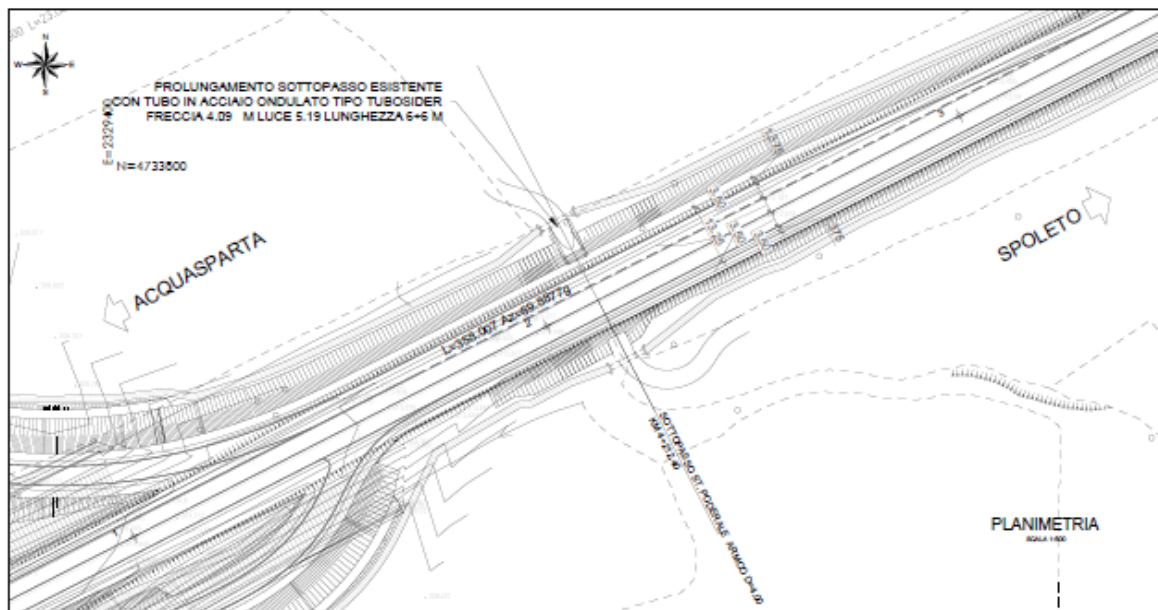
Stralcio planimetrico del sottopasso in lamiera da prolungare, ambito Svincolo di Baiano.
